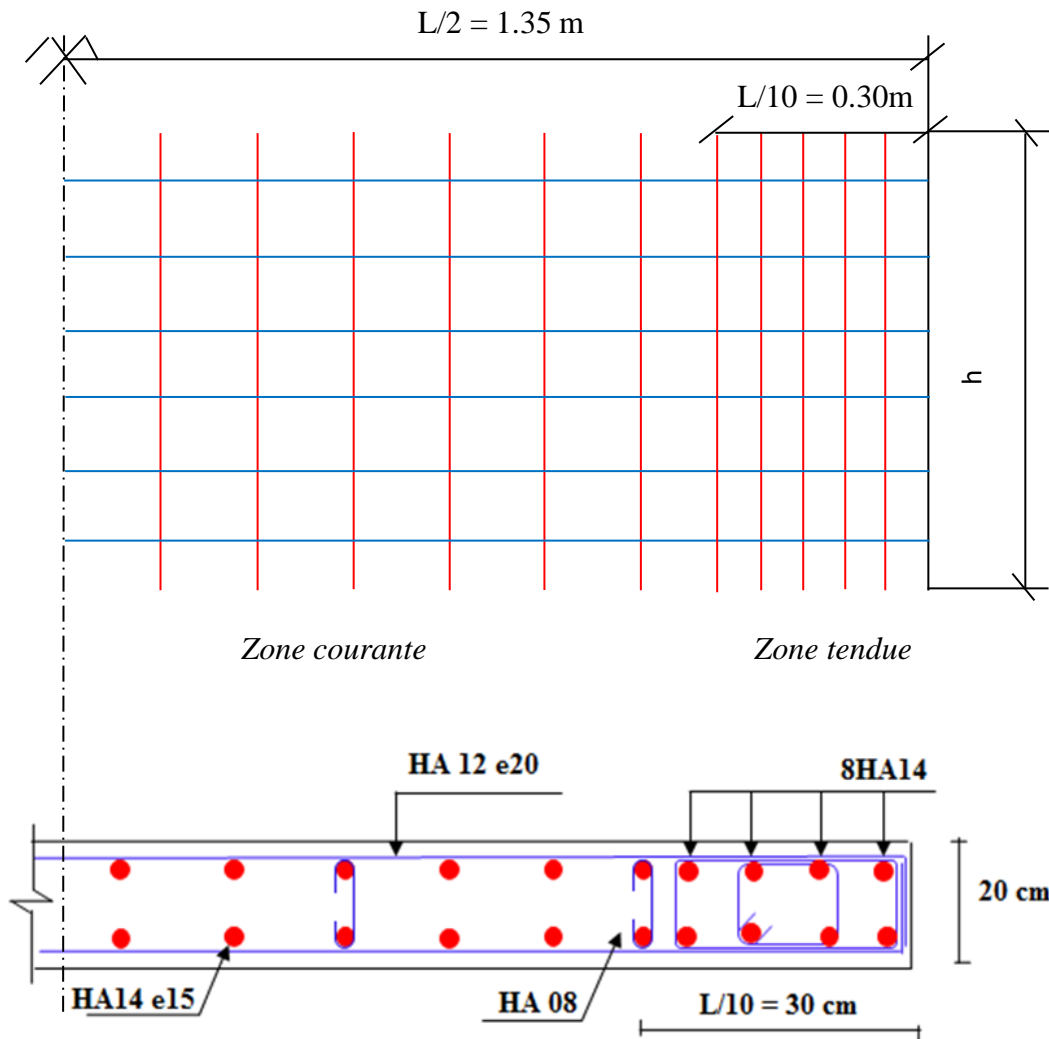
ferrailage du voile – 2^{ème} choix
